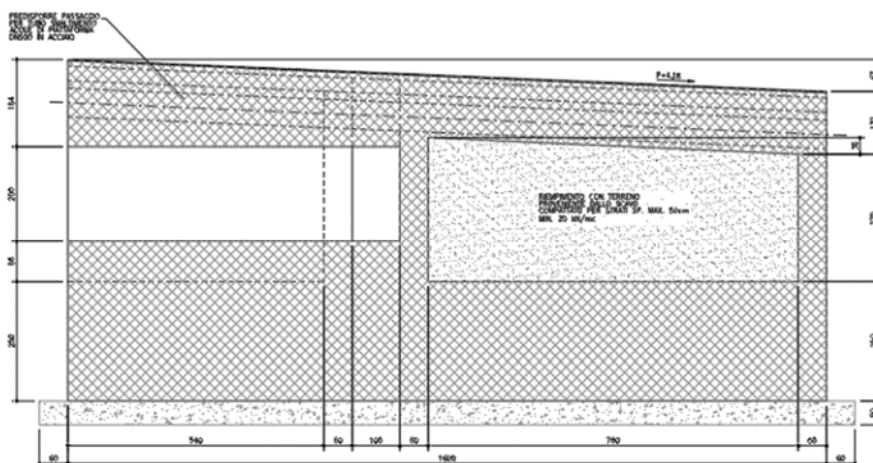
Sezioni longitudinali spalla B
